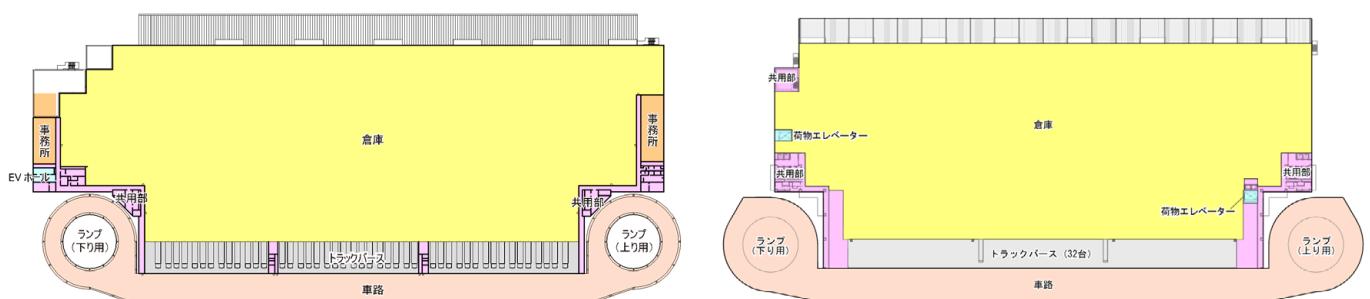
4 階平面図【変更前(左)、変更後(右)】
